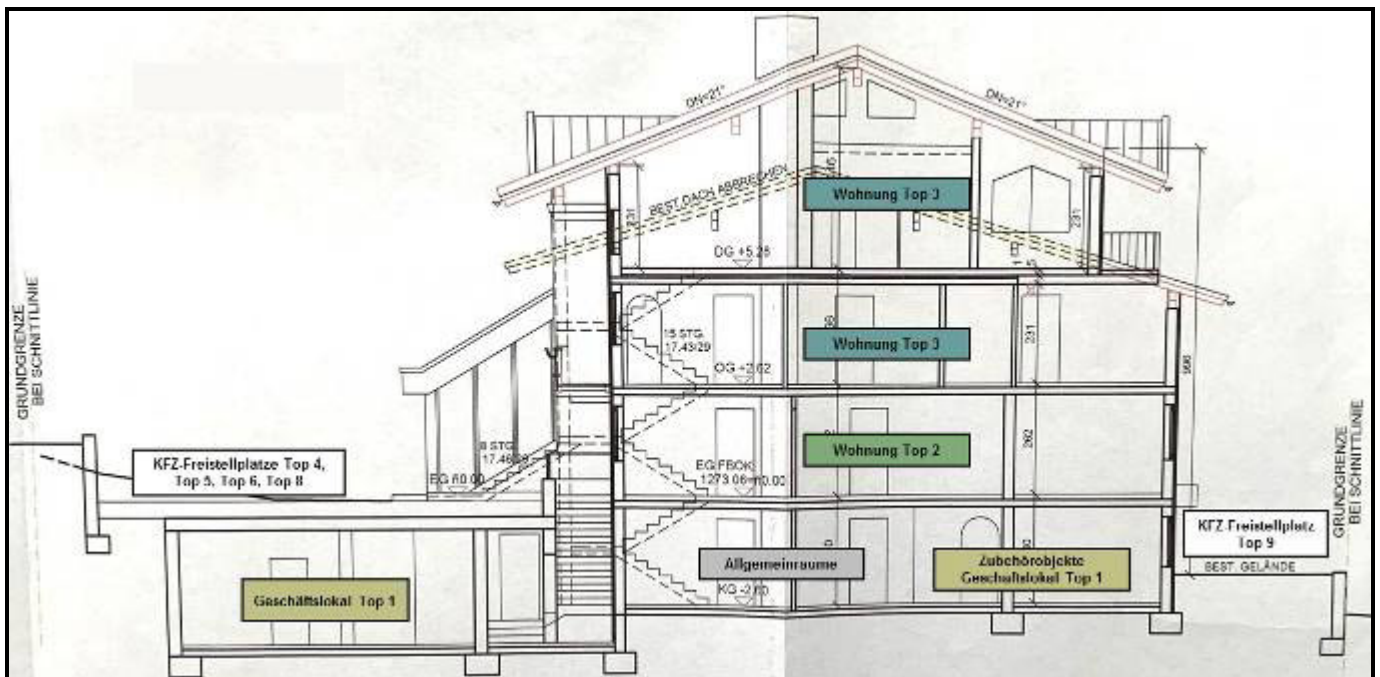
Gebäudeschnitt - Lage WE-Objekte
